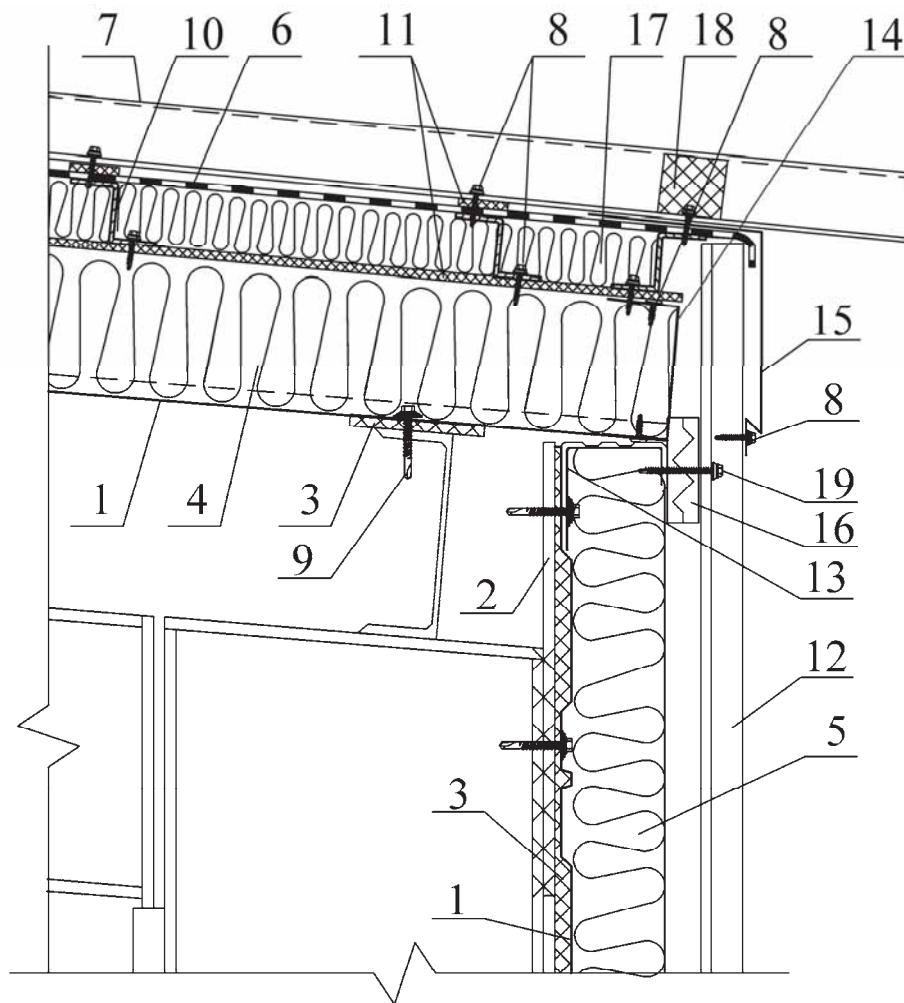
Узел сопряжения стены с кровлей Вариант «2»
